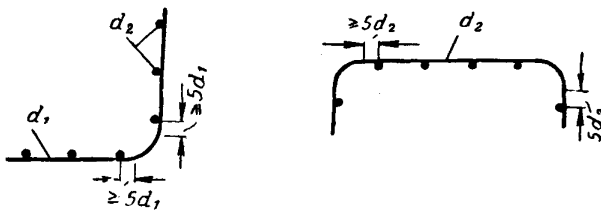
Сварная сетка с гнутыми стержнями одного направления
